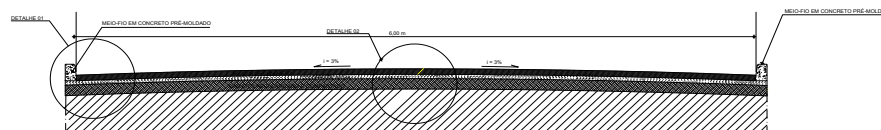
MEIO-FIO E SARJETA - PISO BLOCO DE CONCRETO
